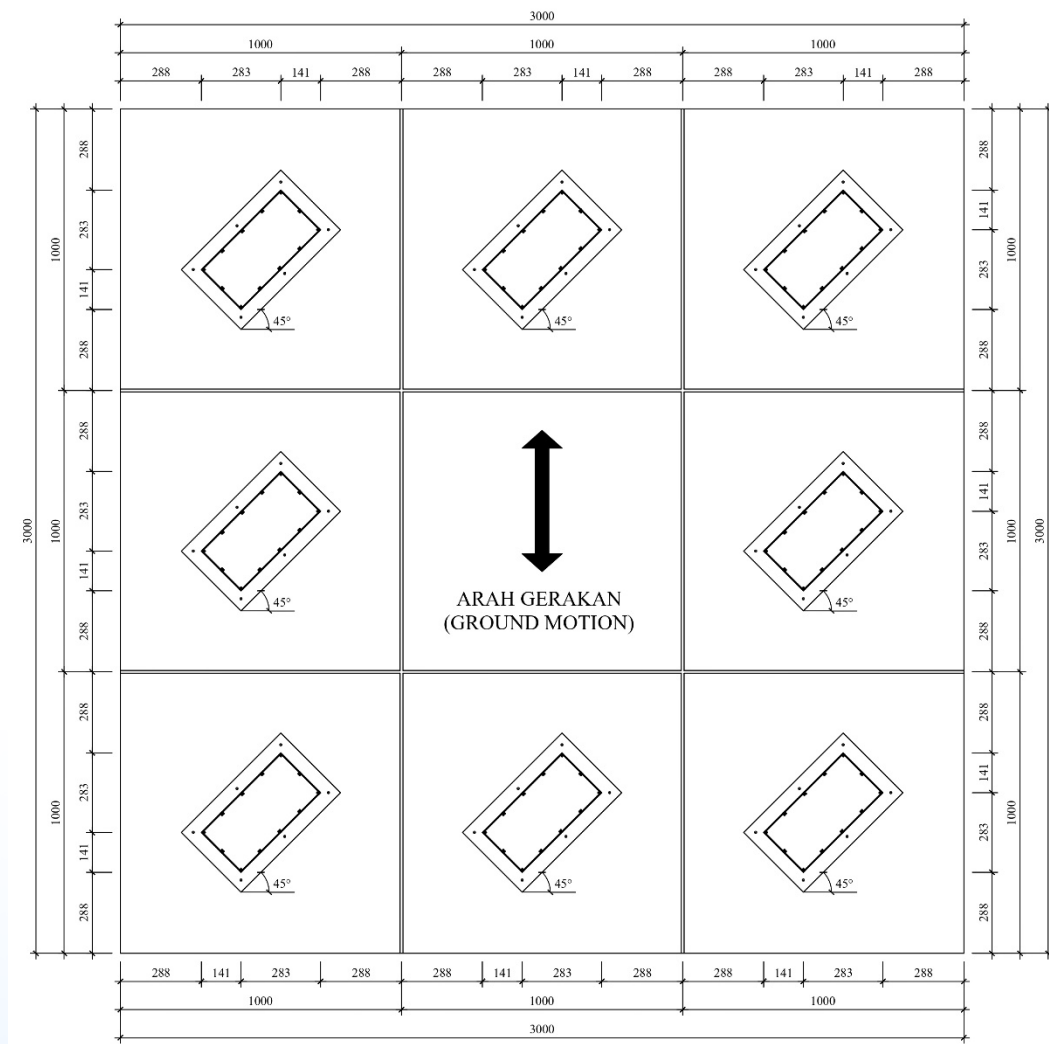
Denah Lantai 1 - 8 Model Bangunan Gedung 8 lantai dari Baja atau Beton Pracetak
